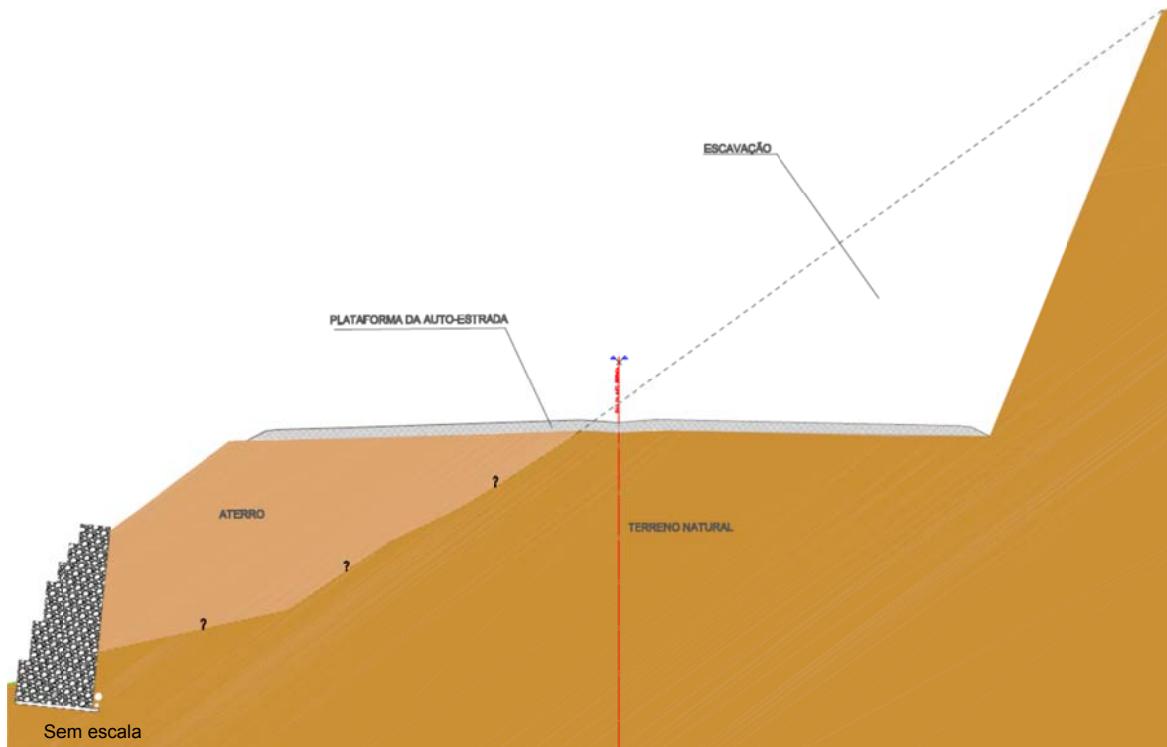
Corte transversal tipo da auto-estrada antes do escorregamento ocorrido.
